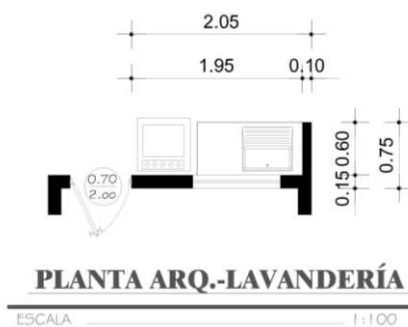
Propuesta de Lavandería para vivienda de interés social
